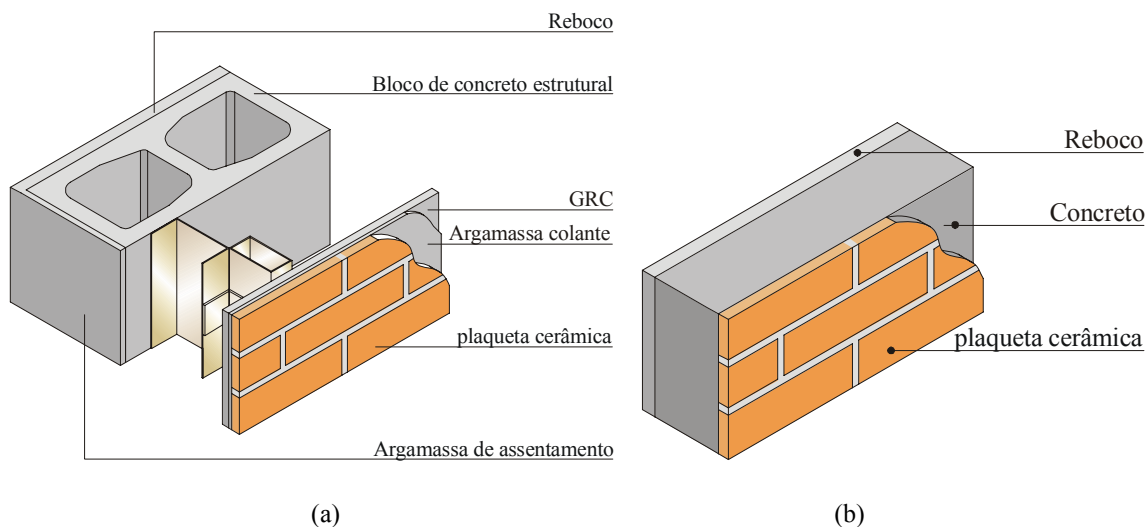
Painel (a) tipo *stud frame* em GRC com plaquetas cerâmicas utilizado na caixa de escada do edifício da faculdade de odontologia e (b) em concreto armado utilizado no edifício garagem.
